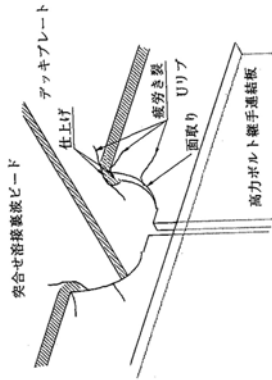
スカラップまわし溶接部の疲労き裂
